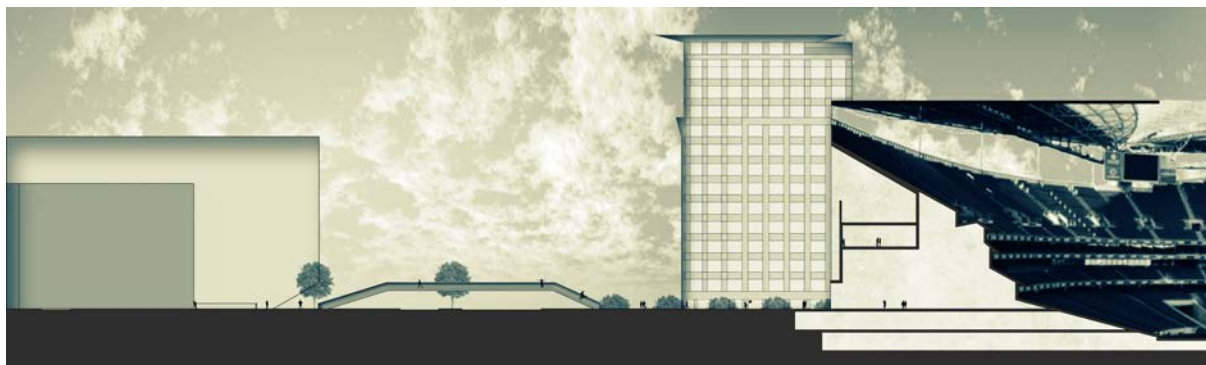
Secção na ligação entre o Estádio da Luz e o Bairro do Calhariz de Benfica (Fonte: Autor)
